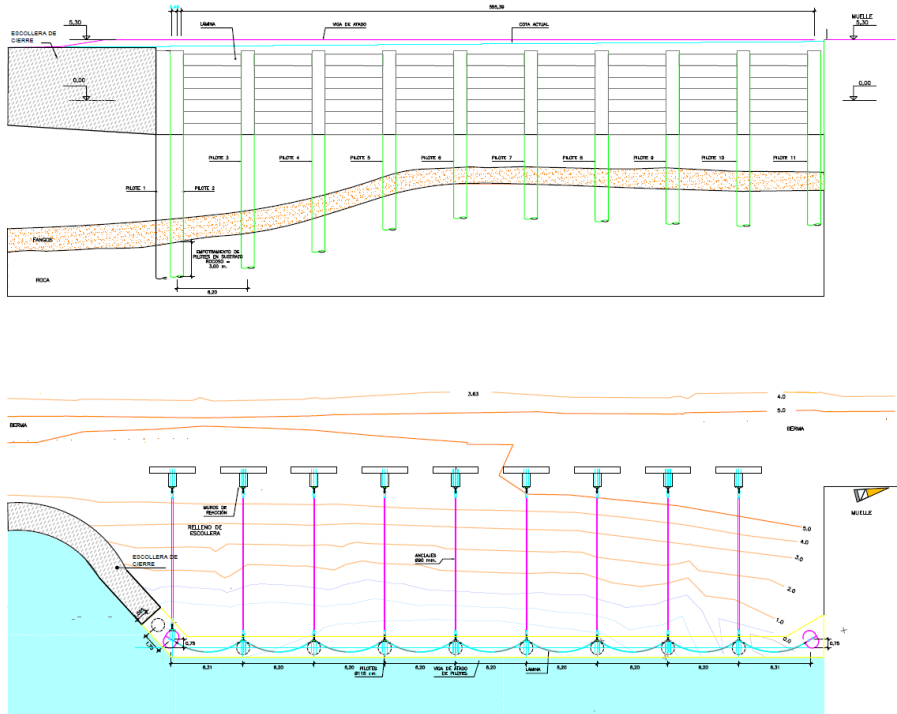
Planta y alzado de la actuación del proyecto PILOTE-LÁMINA.
